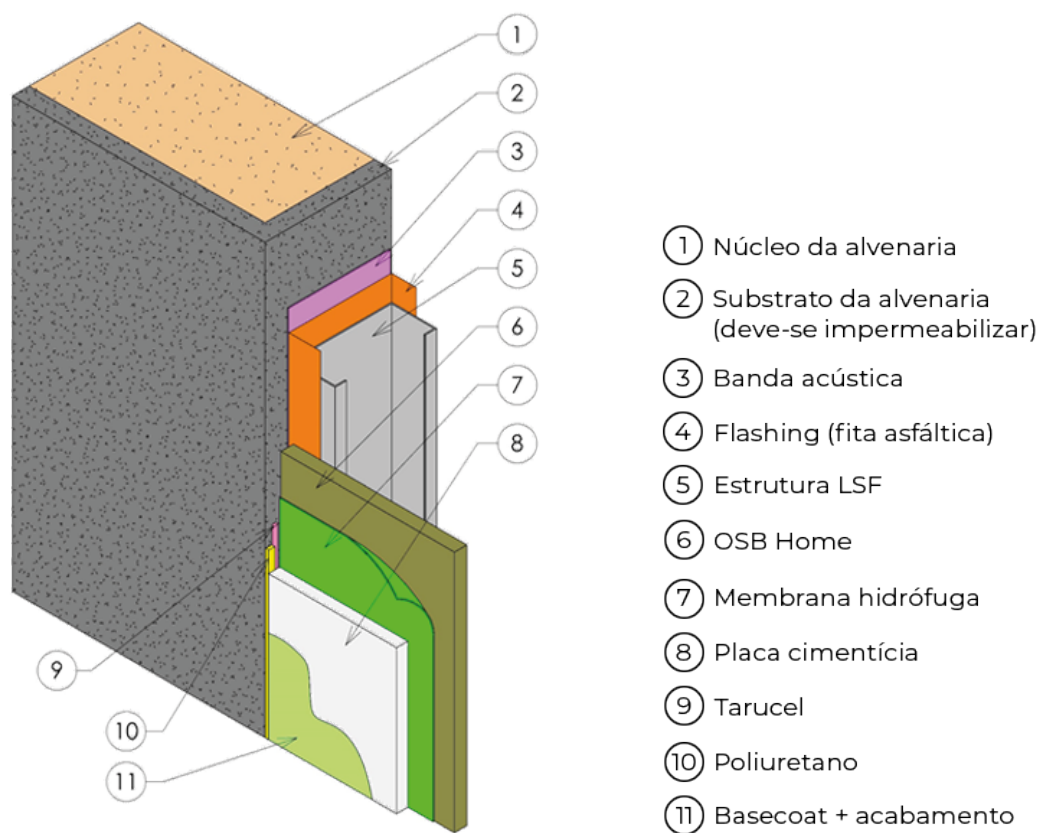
Parede LSF longitudinal a parede em alvenaria
